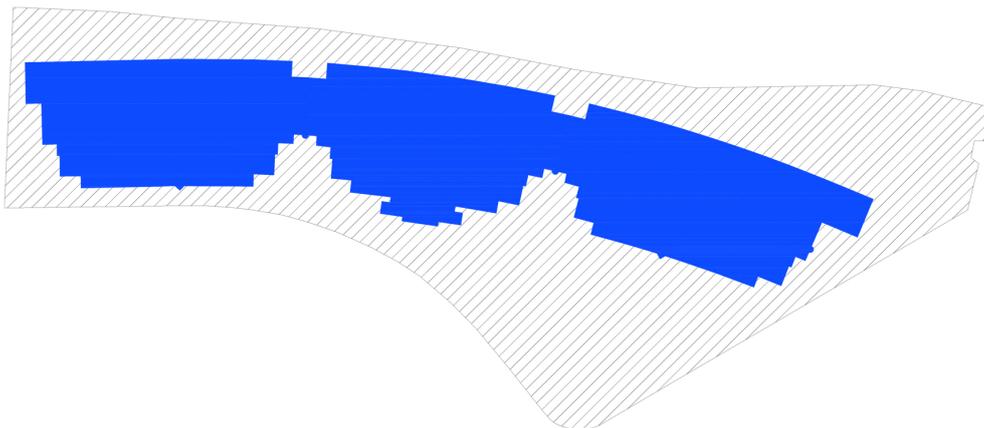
Localisation des bâtiments sur le plan cadastral d'Auderghem
